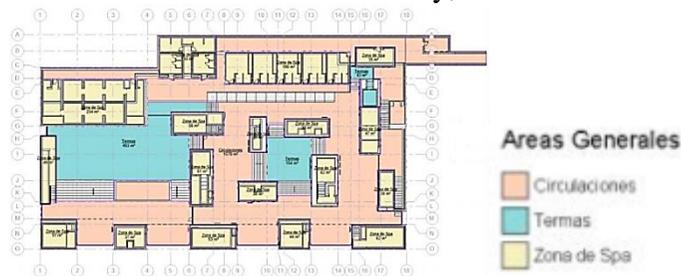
Plano de distribución de segundo nivel. Fuente: Archdaily, 2015
